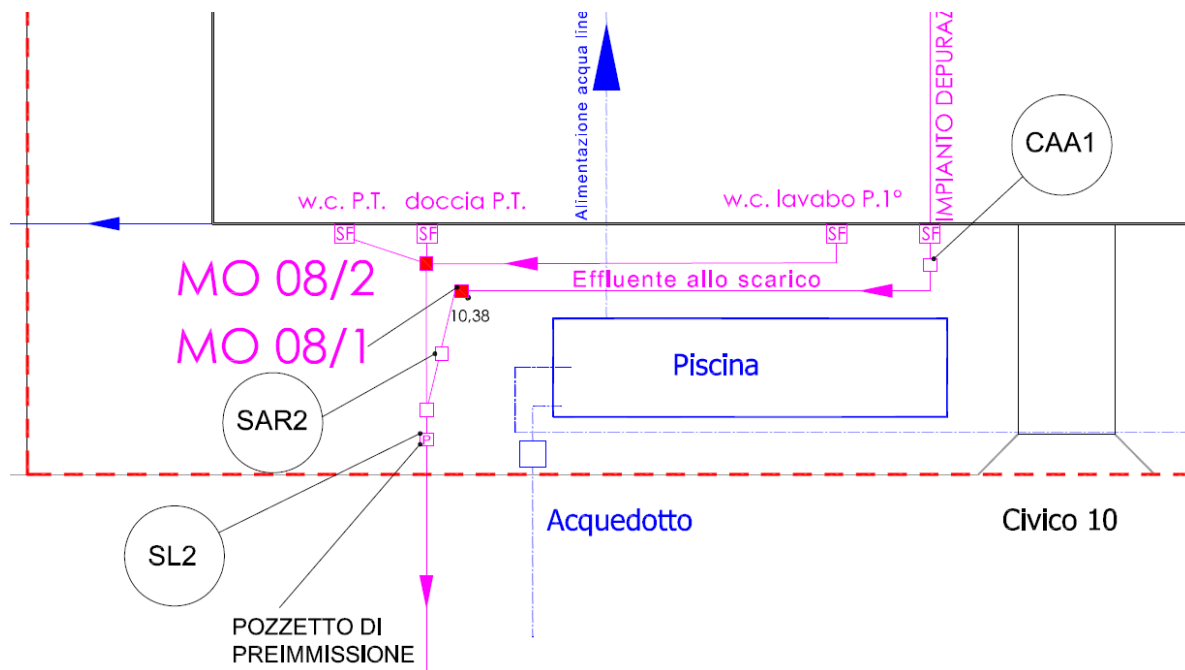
Estratto Tavola 2 – ubicazione pozzetto fiscale
